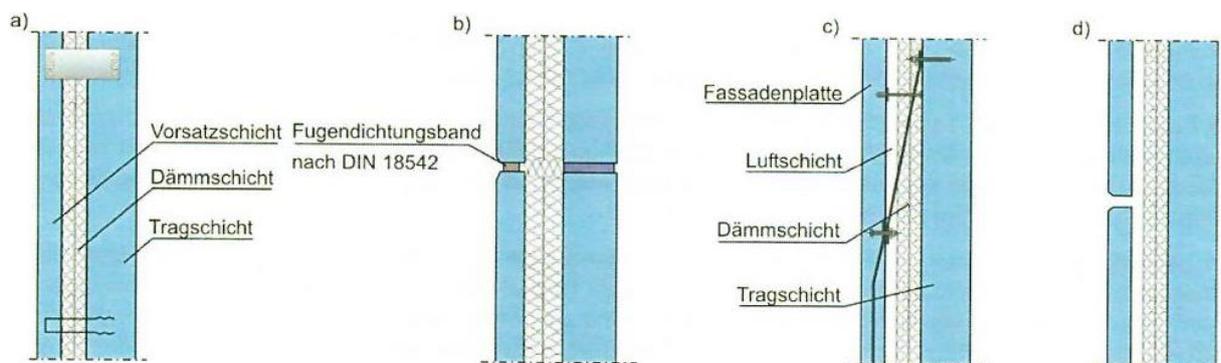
Prinzipielle Fassadenausbildungen und typische Fugendetails, a) und b) Sandwichelemente, c) und d) vorgehängte Fassadenplatten
